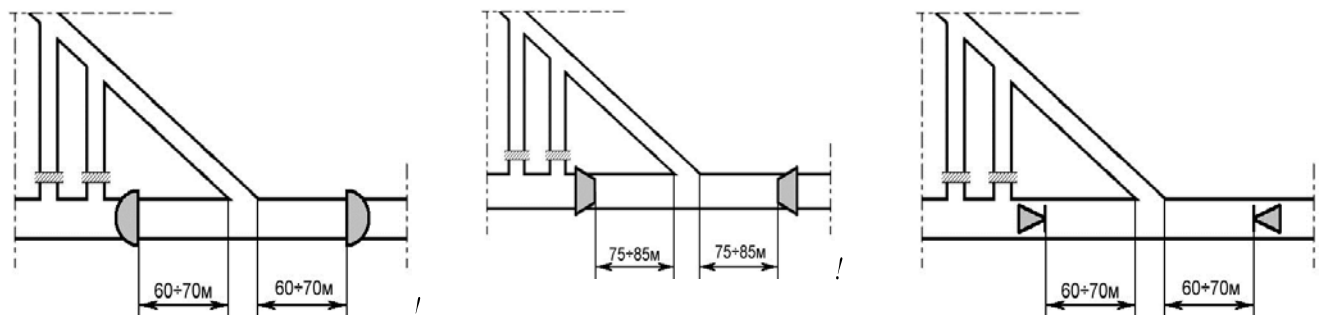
Схемы установки заслонов в конвейерной и вентиляционной выработках у сопряжений данных выработок с бремсбергами, уклонами, квершлагами
